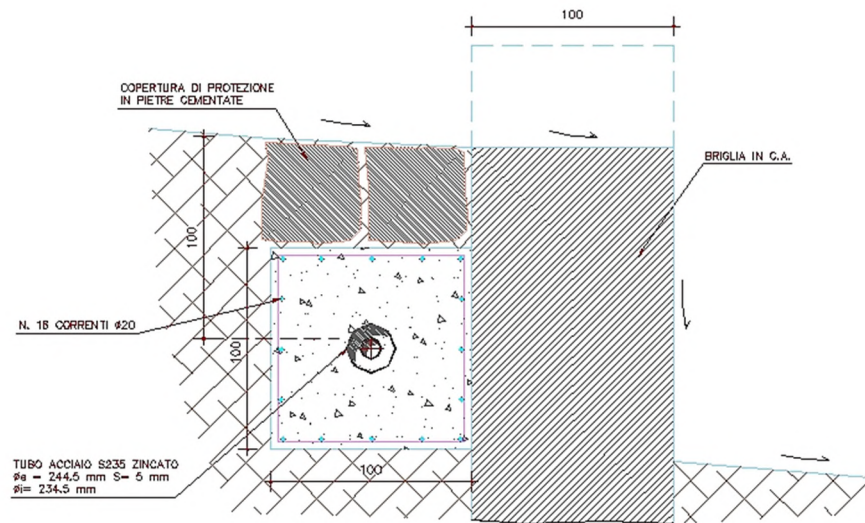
PUNTO A ATTRAVERSAMENTO FOSSE DELLE SASSAIE
